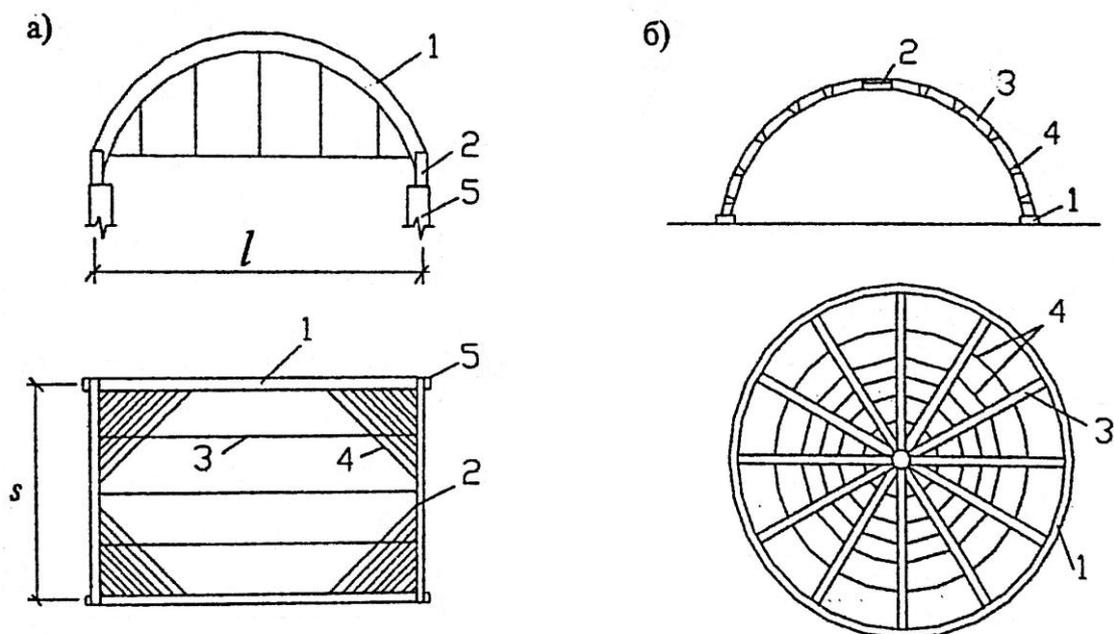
Схема короткой цилиндрической оболочки и купола
